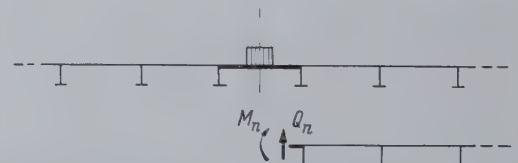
Innenfeld einer Platte auf unendlich vielen Querträgern
